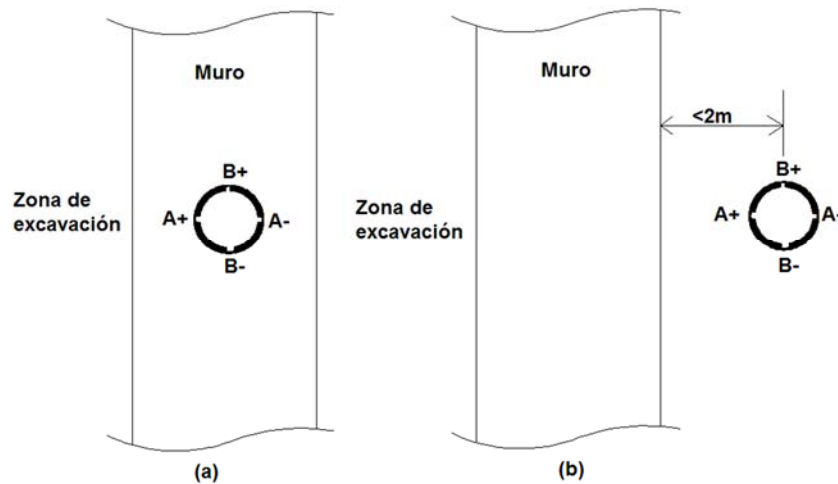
Vista en planta de la Instalación de las cubiertas del inclinómetro con muros diafragmas: (a) instalado en el muro diafragma y (b) instalado por fuera del muro diafragma. Tomado de (Ou, 2006)
